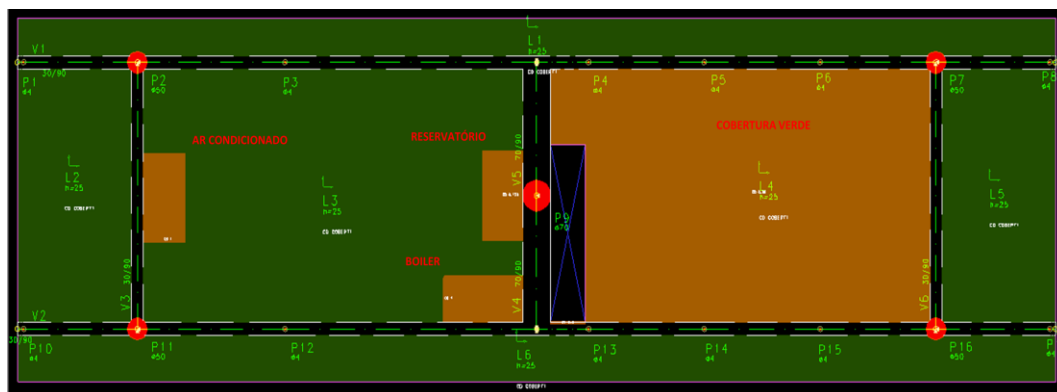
Planta da cobertura, após lançamento dos elementos estruturais e inserção das cargas adicionais.
